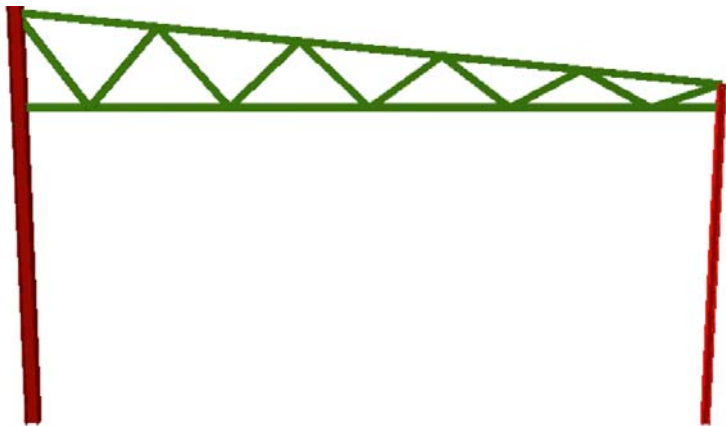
Pórtico tipo de la estructura auxiliar. Fuente: Propia
